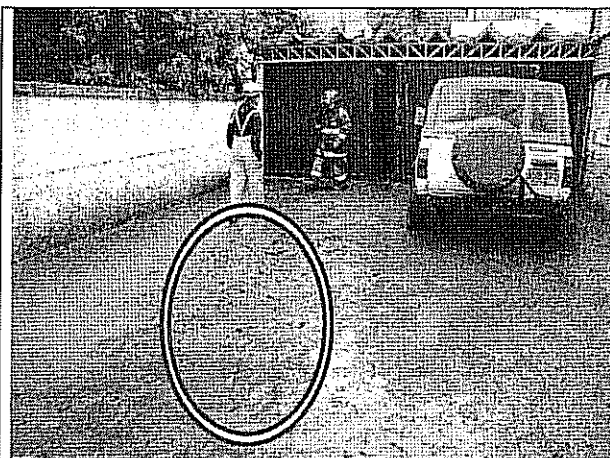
Inundación del primer nivel de la vivienda de la Calle 110B No. 0-28.
